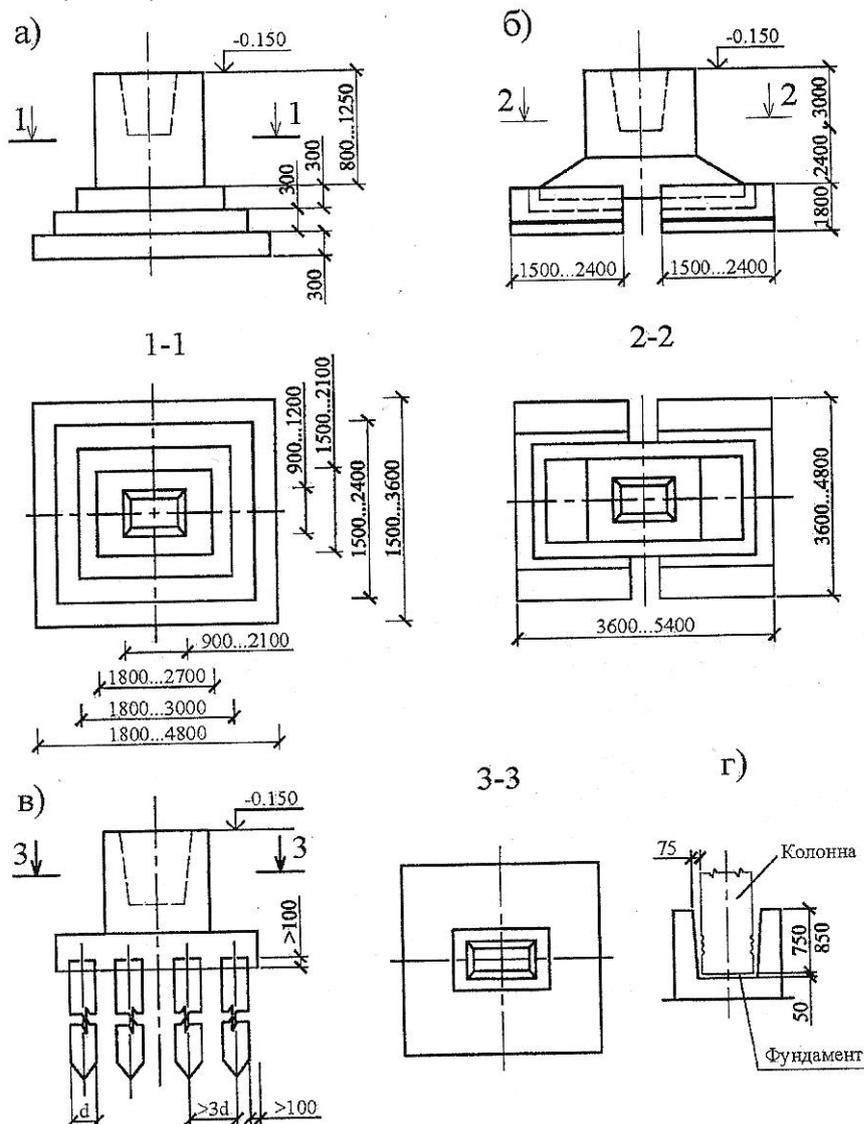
Фундаменты под железобетонные колонны: а- монолитный, б- сборный, в – свайный, г- заделка колонны в фундаменте
